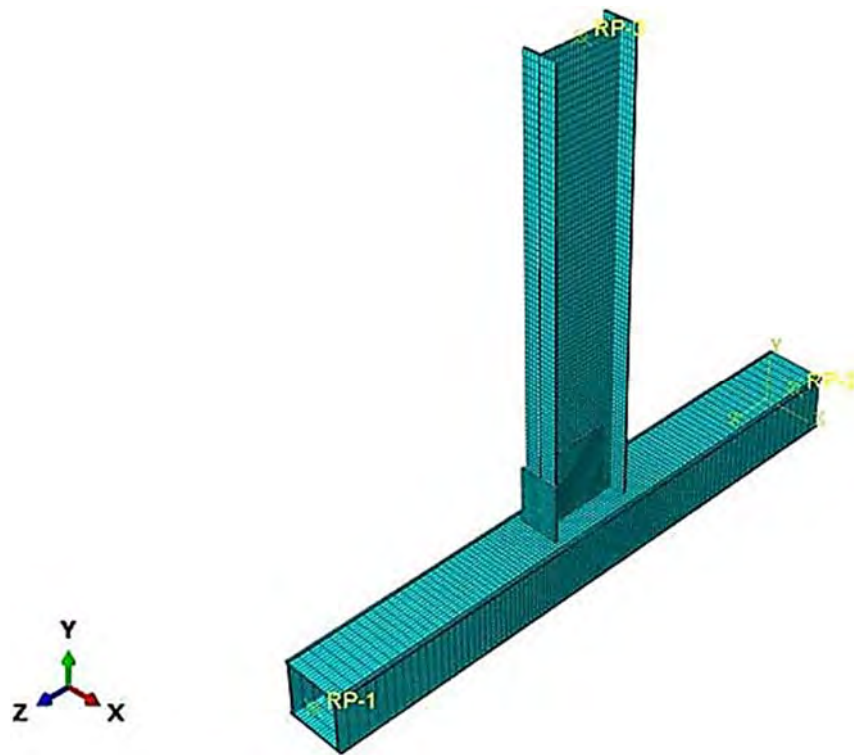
Mallado en la conexión soldada en columna cajón.
